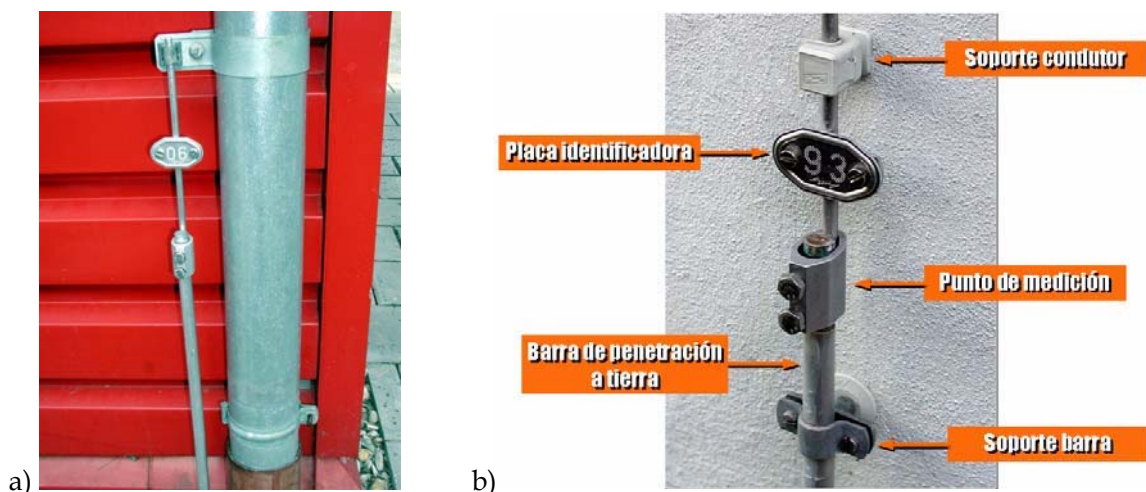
Conexión a tierra de la tubería del canalón de lluvia y equipotencialidad de la chapa metálica (a). Conexión al sistema de puesta a tierra (b).
